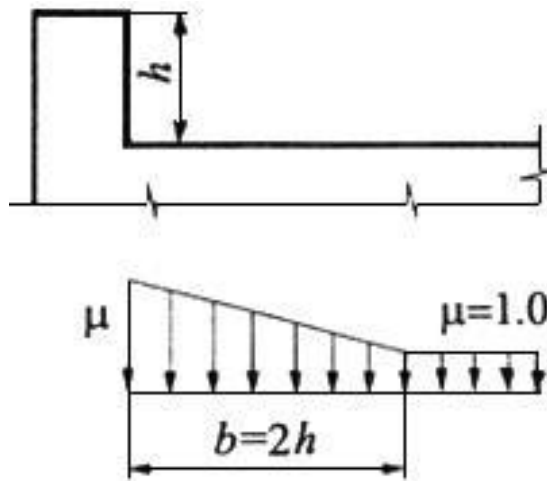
Схема нагрузки на покрытие возле парапета
